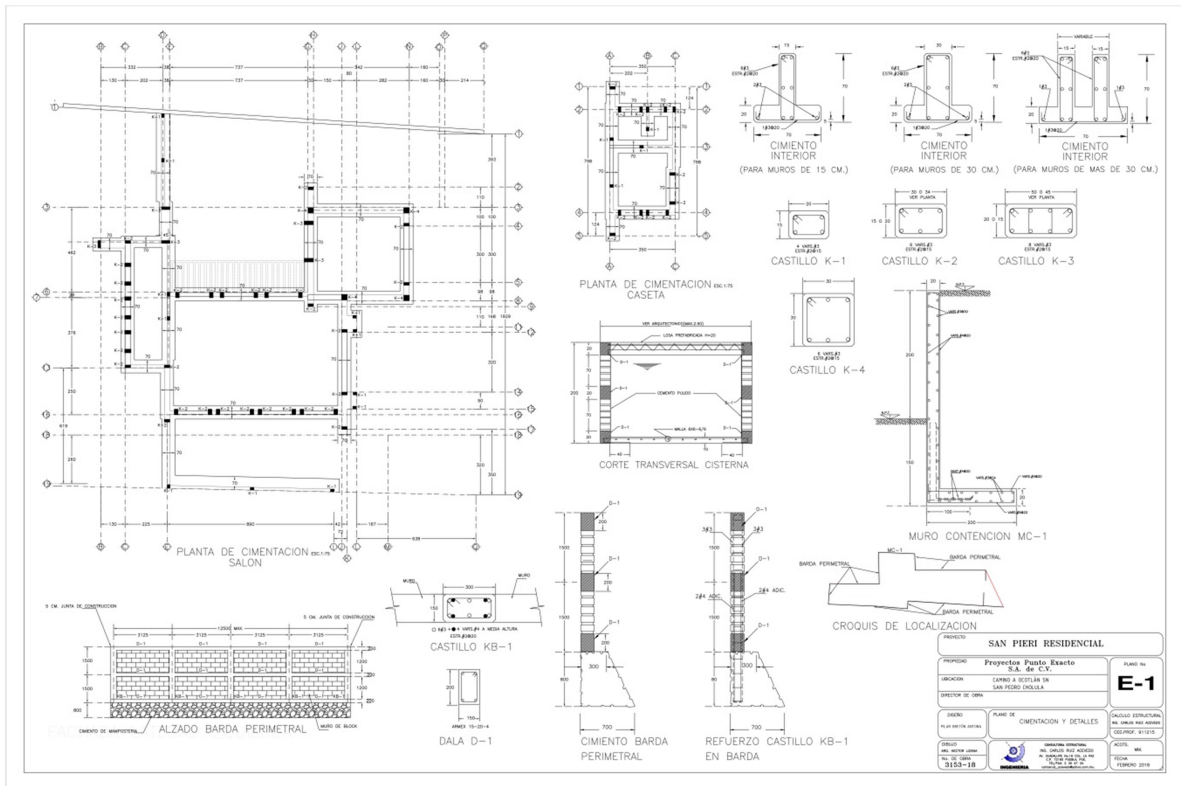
Plano estructural de casa club, otorgado por Proyectos Punto Exacto.
